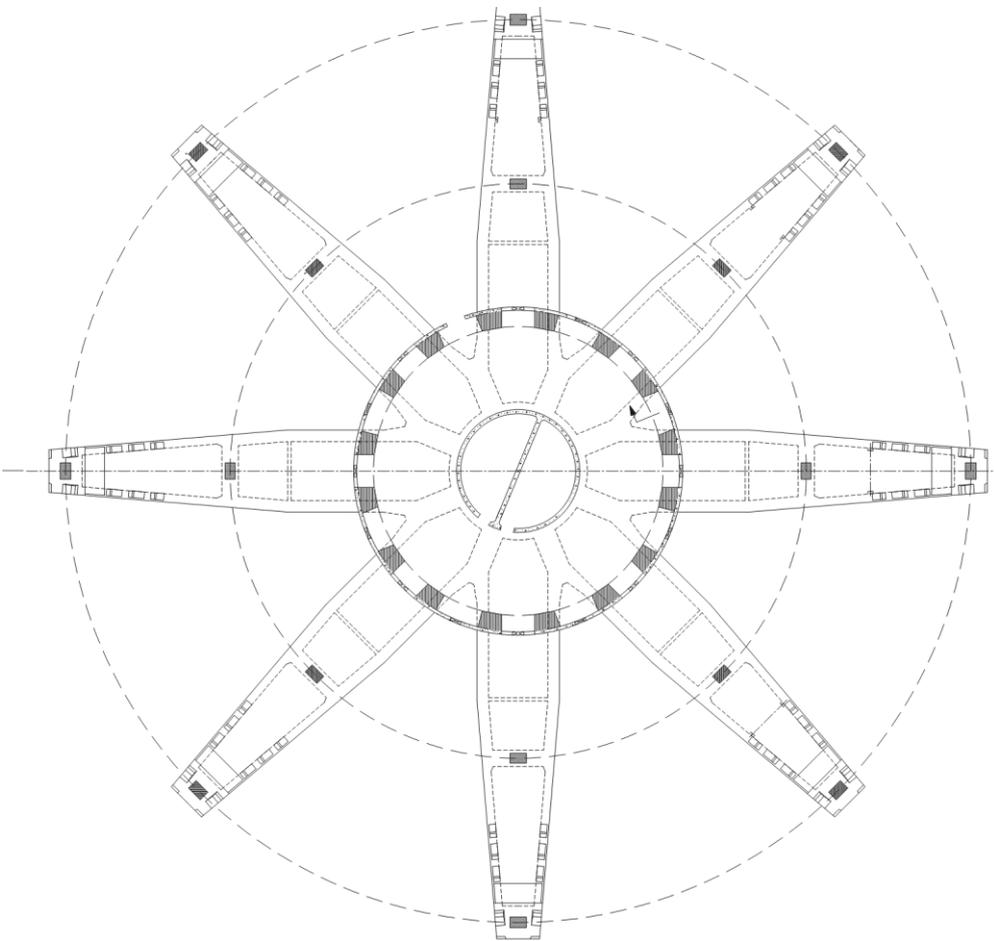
Planta estrutural da estrela. Fonte: Arquivo da PGR.
